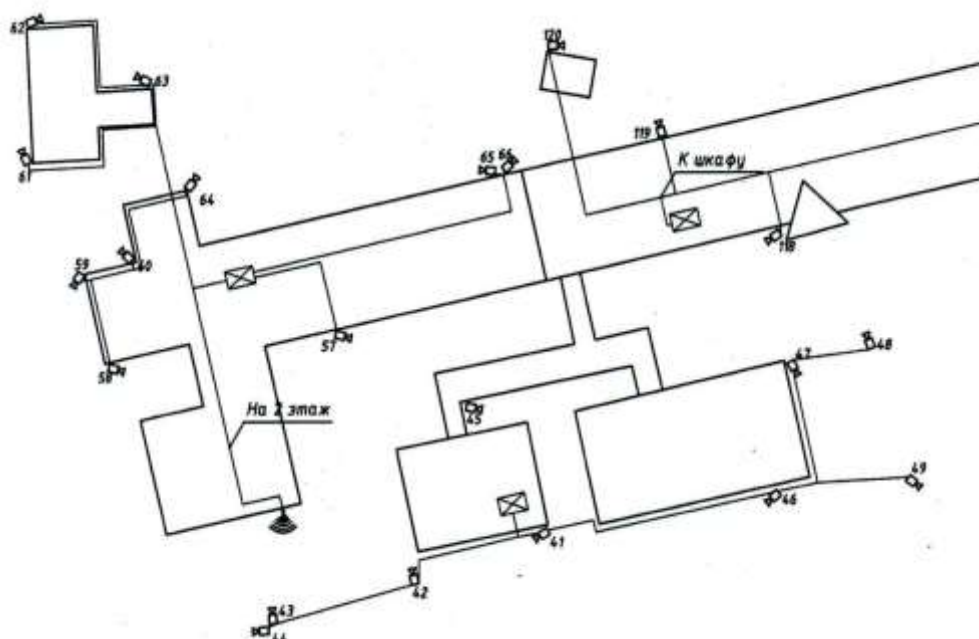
Схема прокладки кабеля от шкафа №5 до видеокамер
